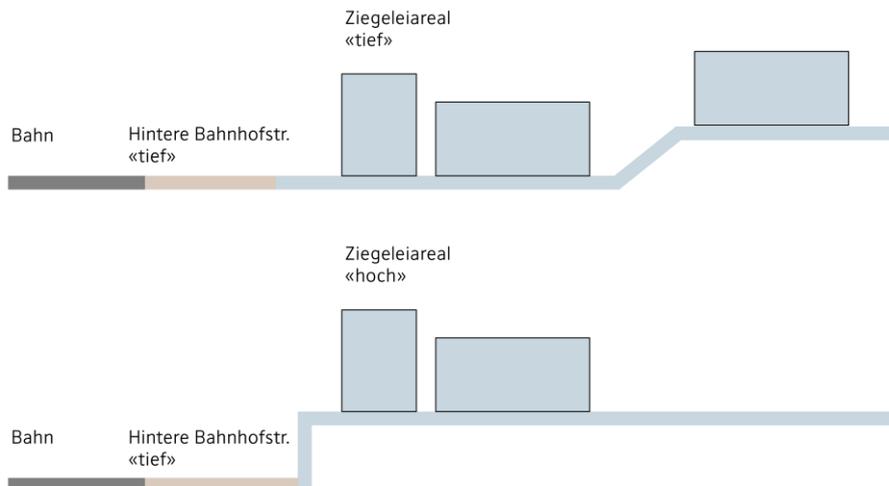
Lage Strasse und denkbare Bebauung Ziegeleiareal
